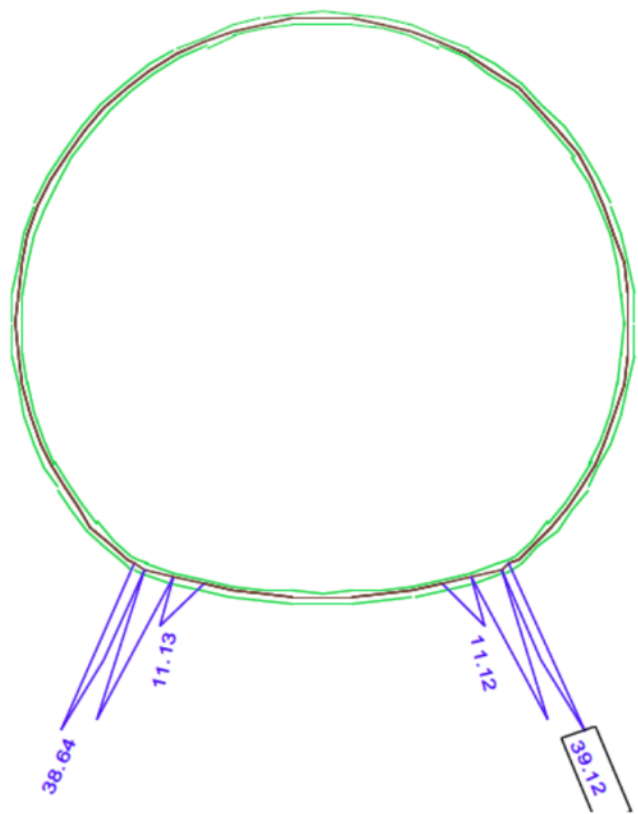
Querkraftbemessung, erforderliche Schubbewehrung in cm^2/m je Laufmeter Tunnel [9]
